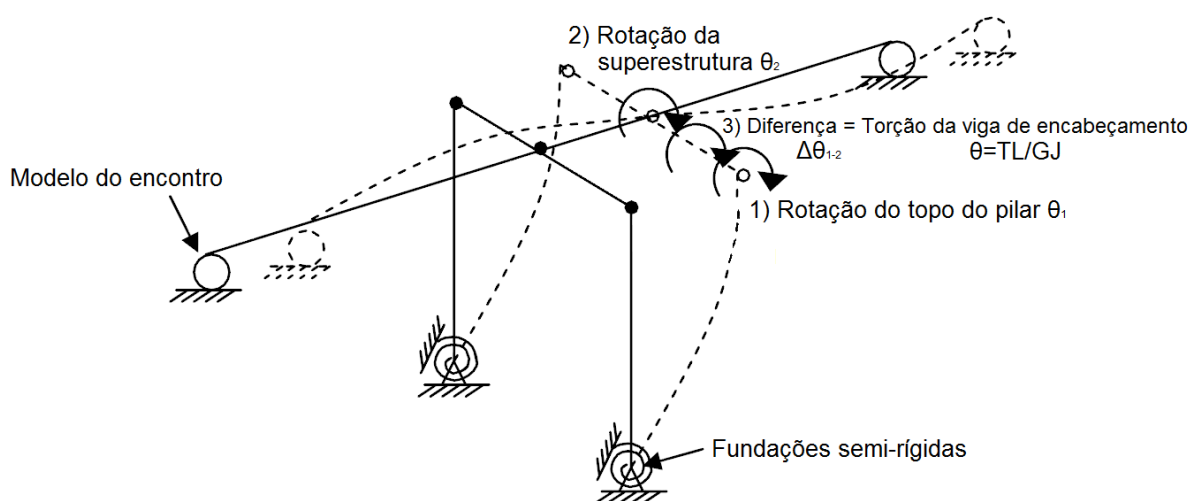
Torção da viga de encabeçamento (*cap beam*).
